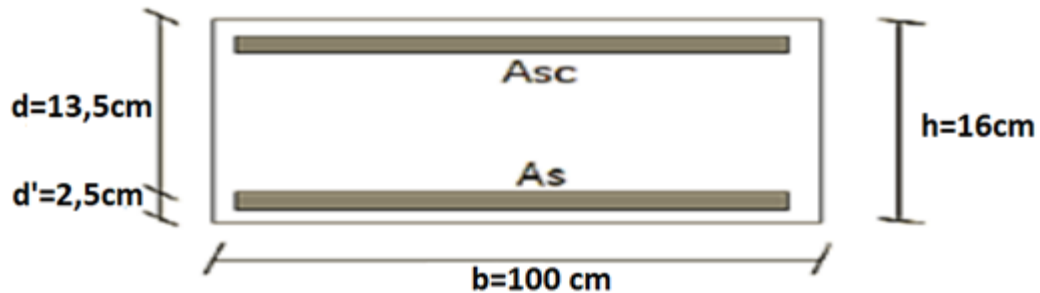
Dimensions de la section transversale du balcon étage courant
